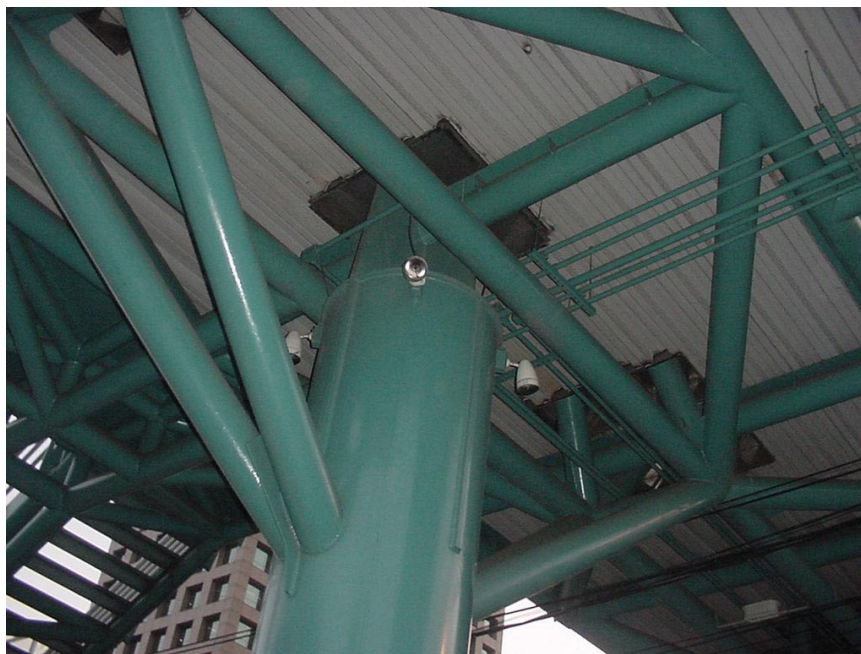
Detalhe do pilar de suporte e composição estrutural
